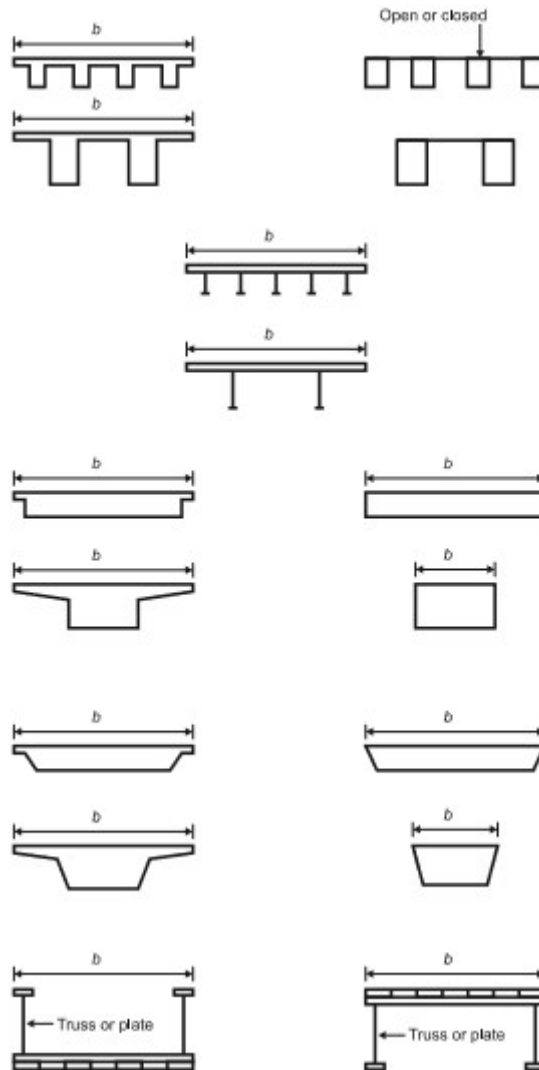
Secções transversais de tabuleiros de construção corrente (EC1, Fig. 8.1)
